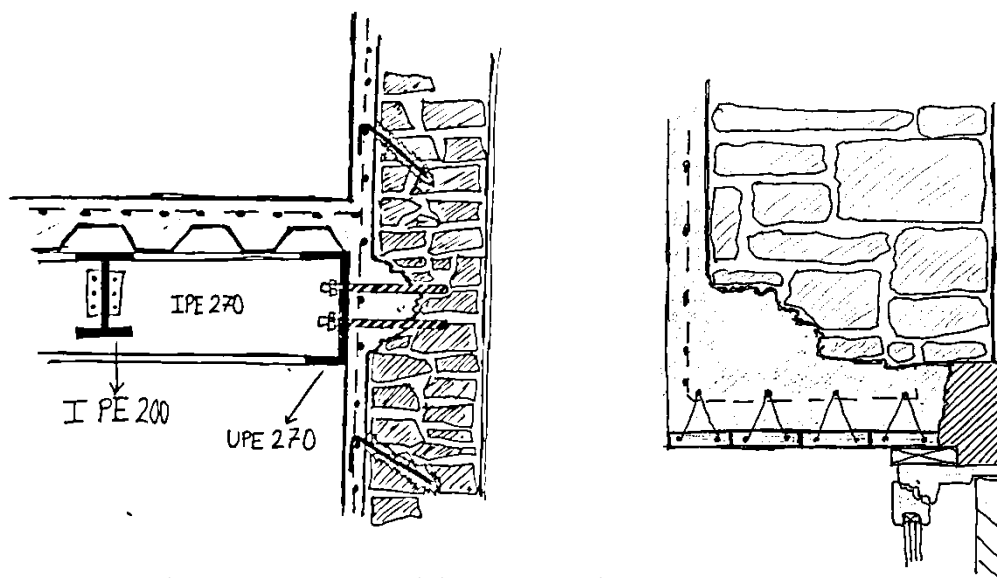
Esquício de pormenor construtivo da laje mista e janelas.
